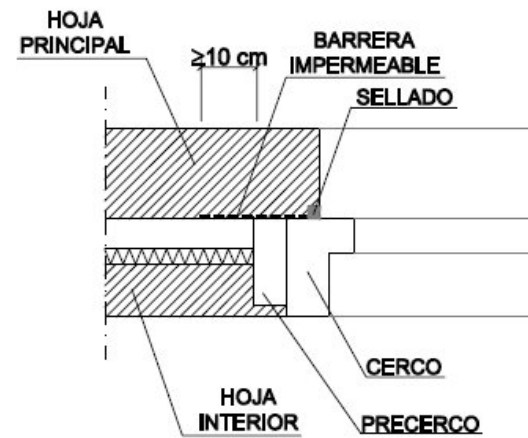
Ejemplo de encuentro de la fachada con la carpintería
